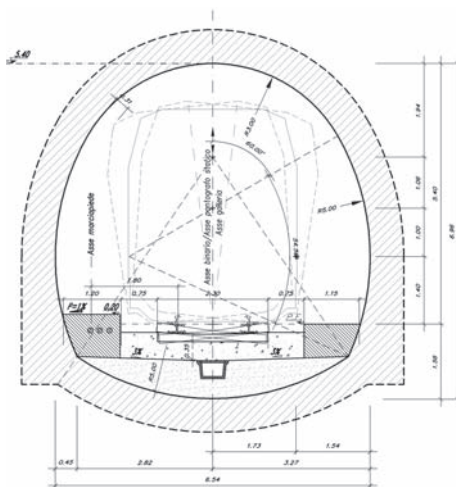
Sezione tipo profilo interno galleria singolo binario (Gabarit B non elettrificabile).
